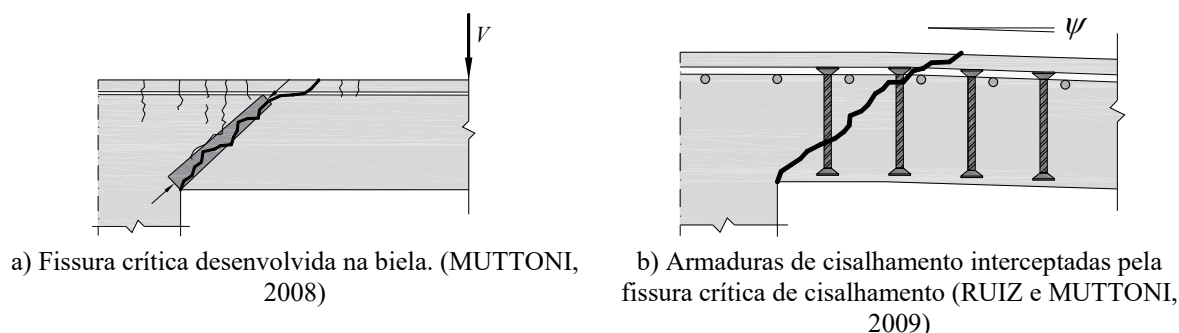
Teoria da fissura crítica aplicada à ligações laje-pilar.
